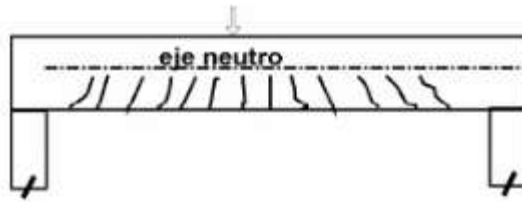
Espino, L. (2006) Agrietamiento debido a la flexión [figura] Recuperado de [https://www.academia.edu/4855502/DISE%C3%91O\\_POR\\_FLEXI%C3%93N\\_DE\\_VIGAS\\_DE\\_CONCRETO\\_REFORZADO.\\_Profes](https://www.academia.edu/4855502/DISE%C3%91O_POR_FLEXI%C3%93N_DE_VIGAS_DE_CONCRETO_REFORZADO._Profes)
